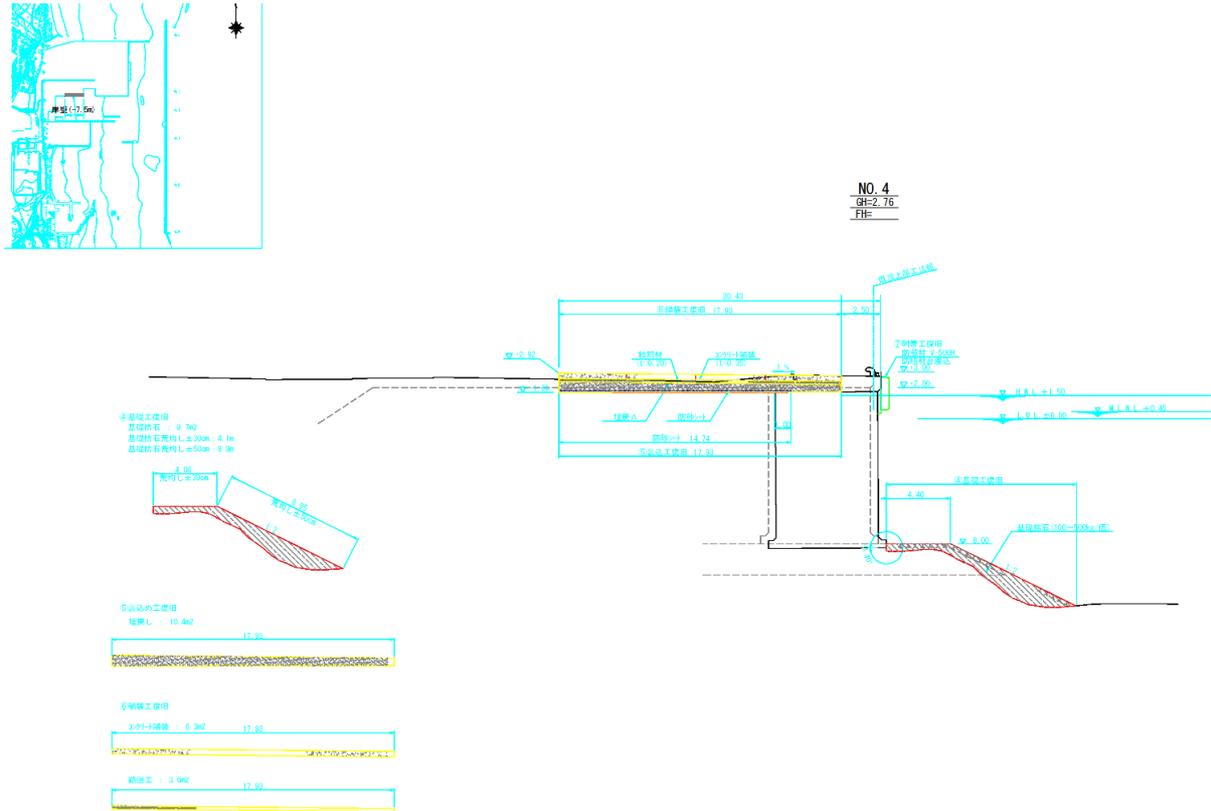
No.16 常陸那珂港区_北埠頭地区 D・E・F 岸壁 (-7.5m) の断面図 (復旧後)
